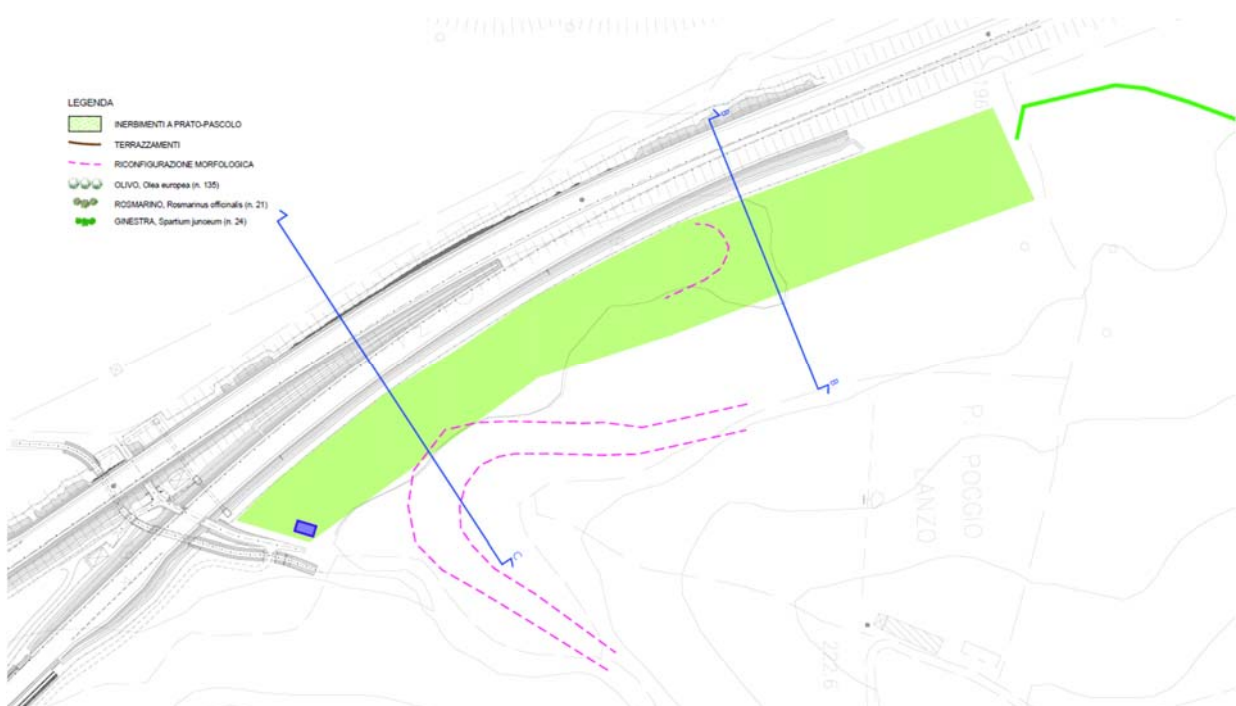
Area di Cantiere 2 – Planimetria della riambientazione
